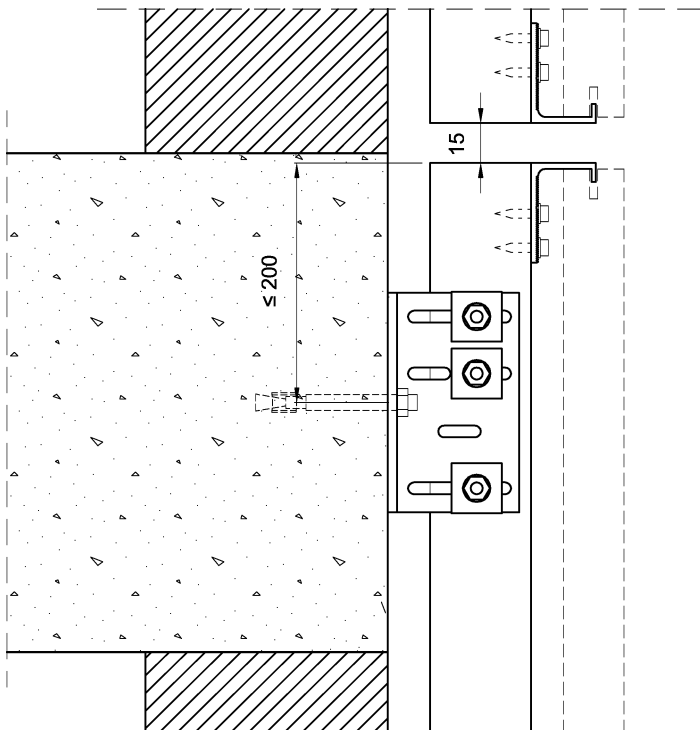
Junta horizontal recomendada entre perfiles verticales.
